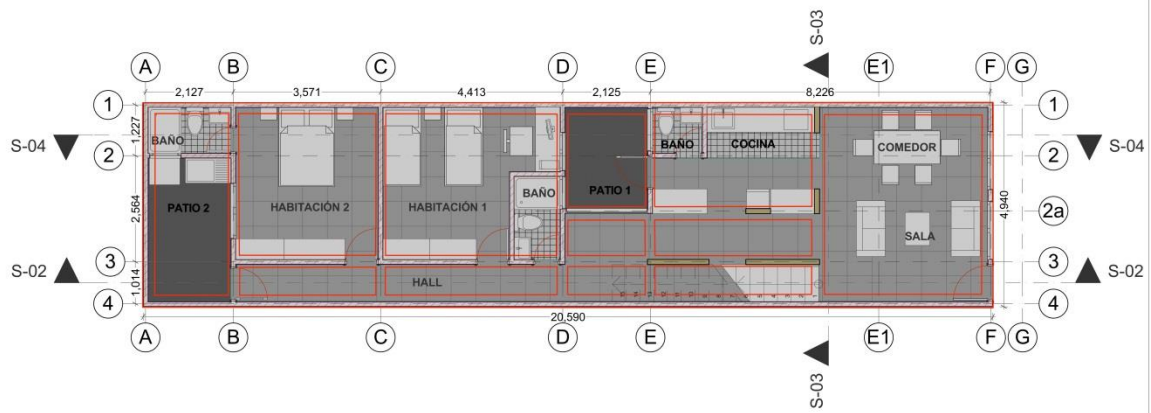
Planta primer piso propuesta indicando planta de ejes, esta cimentación proyectada bajo los muros existentes y los propuestos, como arranque de estos para hacer una correcta distribución y transmisión de cargas hacia el suelo. Elaboración propia 2017.
